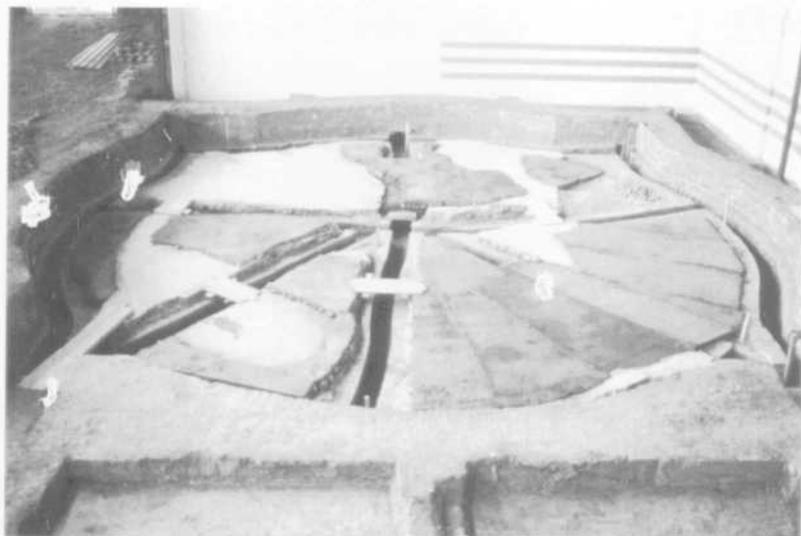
Foto K: Disposición de la nueva solera de hormigón, soporte del *tessellatum
